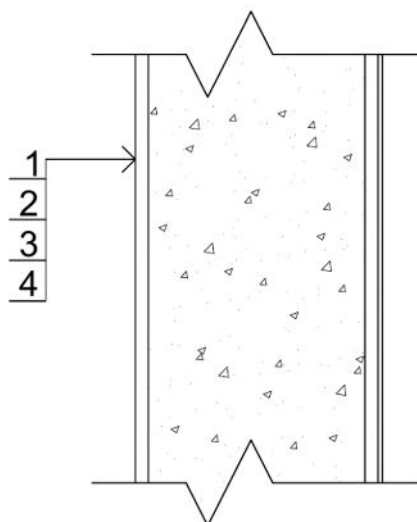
Расчетная схема ограждающих конструкций из газобетона: 1 – внутренняя отделка; 2 – газобетон; 3 – наружная отделка; 4 – фасадная краска
